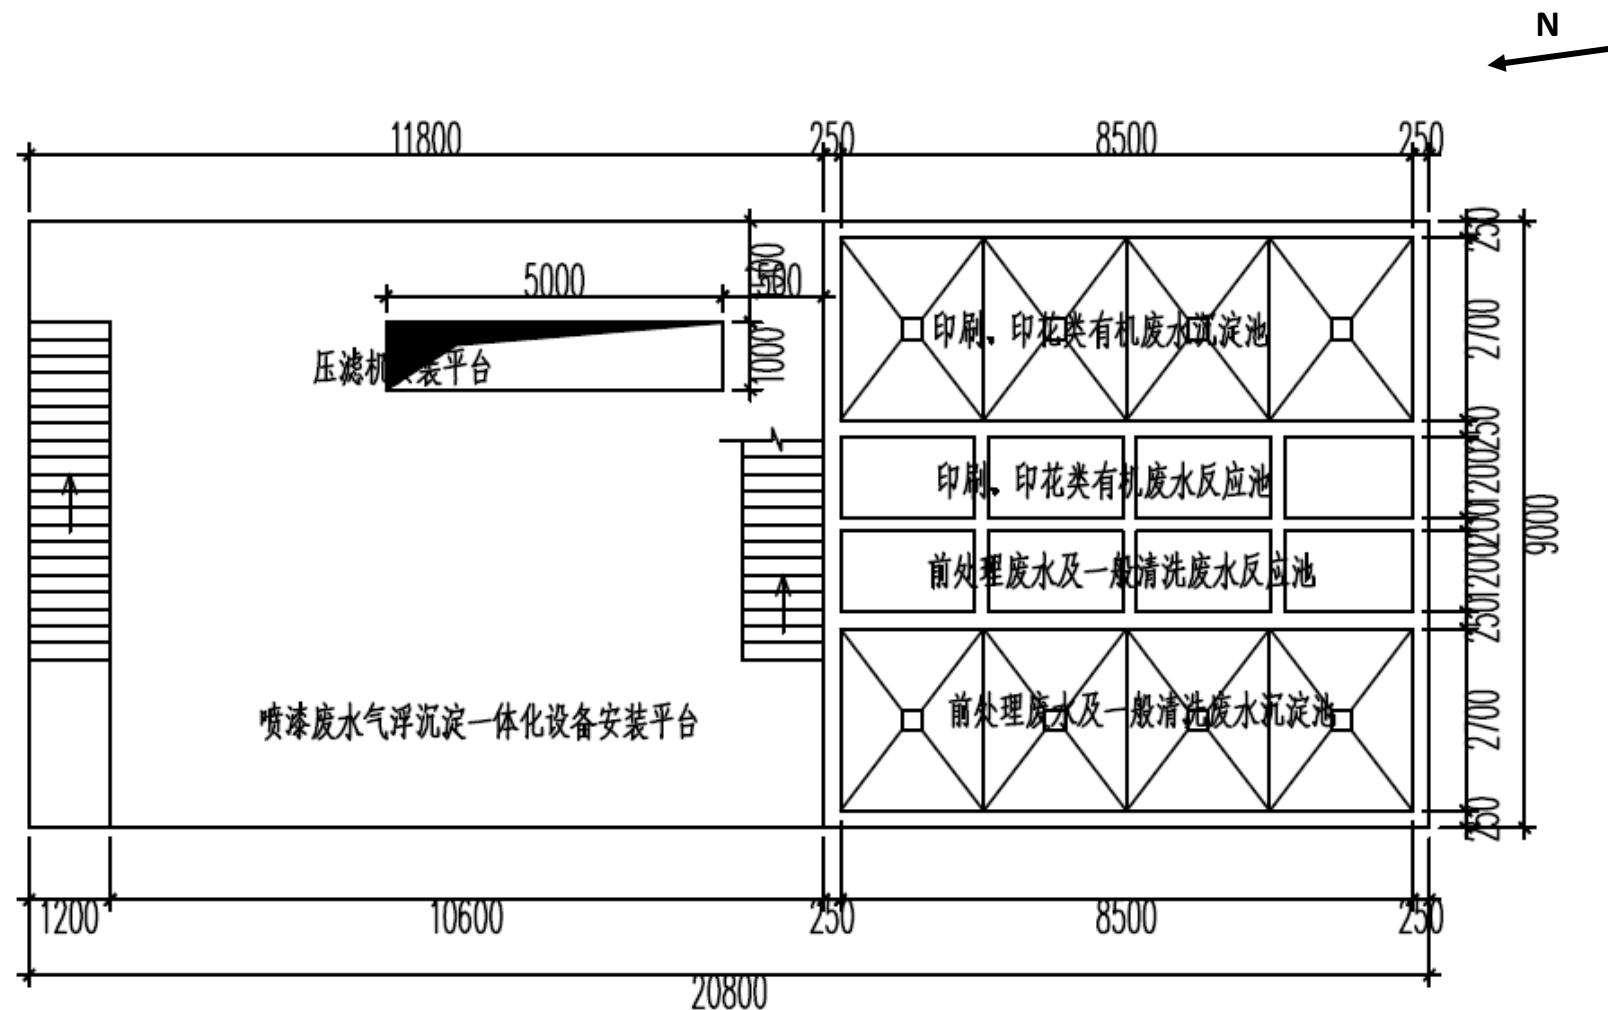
处理构筑物2三层平面布置图 (5.5~9.8m)
